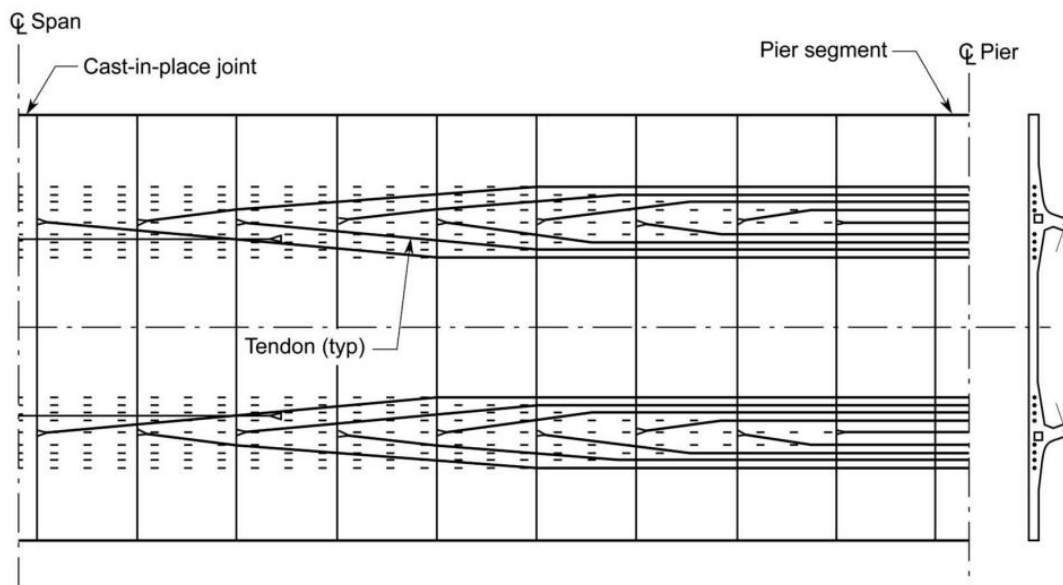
Recomendaciones del tensionamiento en fibra superior de los voladizos compensados. Planta. Fuente: (Dongzhou & Bo , 2020)
